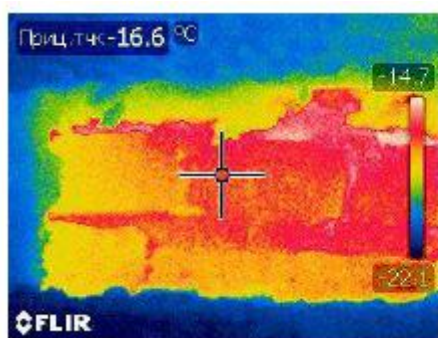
Термограма відкритої порожнини кладки без утеплювача
